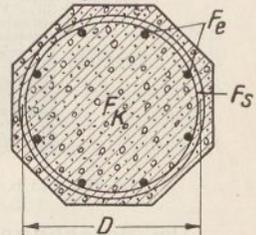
Eisenbetonsäule. Umschnürte Säule.
